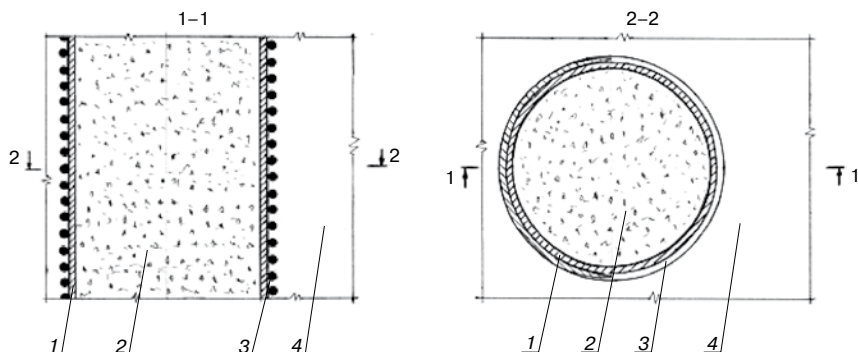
Продольное 1–1 и поперечное 2–2 сечения фрагмента трубобетонного элемента круглого поперечного сечения с навивкой по спирали напрягаемой арматуры в теле железобетонной конструкции: 1 – предварительно напряженная оболочка; 2 – ядро из бетона внутри оболочки; 3 – арматура, навитая по спирали с натяжением по наружной поверхности оболочки; 4 – тело железобетонной конструкции
